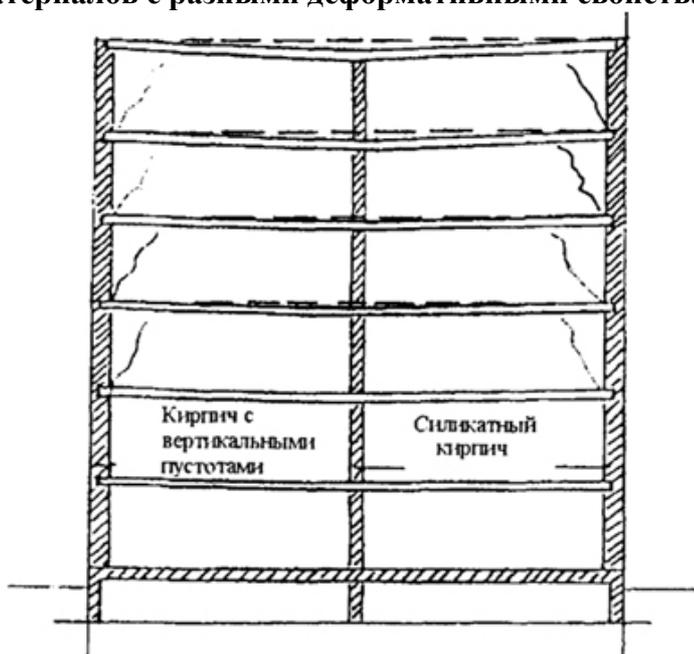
Схемы трещин, возникших в стенах от воздействия перекрытий
